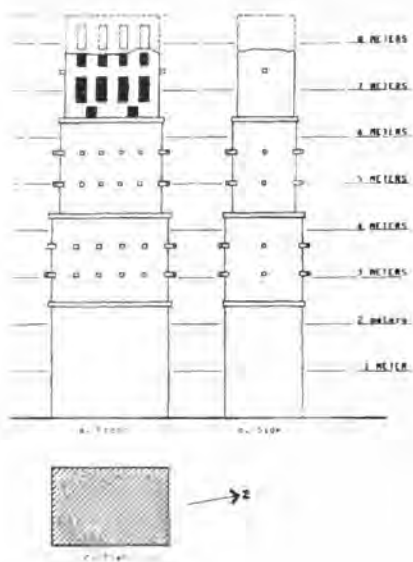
Estructura 2 de Nocuchich, Campeche. Planta, vista frontal y vista lateral. Figura 3. Estructura 1 de Chanchén, Campeche. Planta, vista frontal y vista lateral. Ambas según Andrews, 1989.
